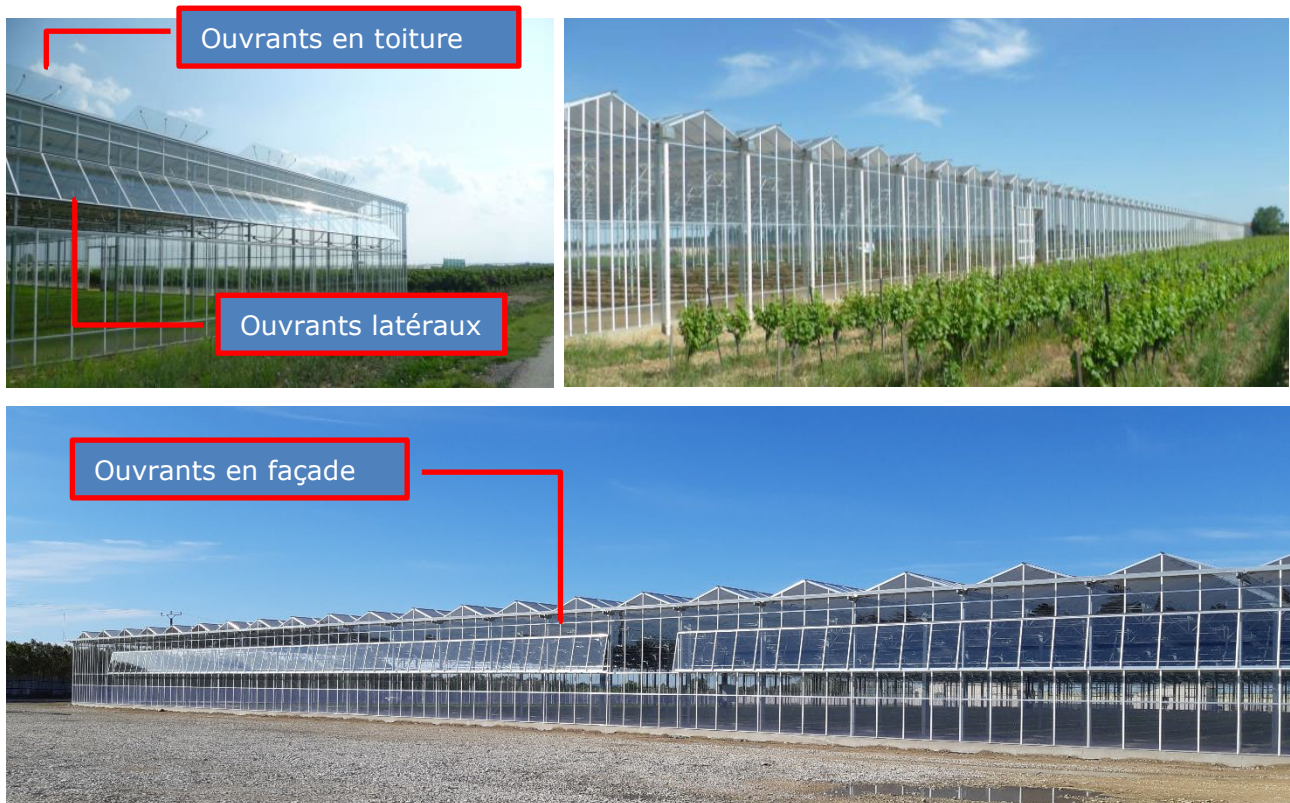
Ouvrants en façade et en toiture. Source : Reden Solar.
